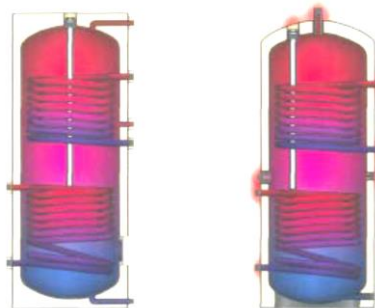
acumulador con las conexiones de entrada y salida convenientemente aisladas con otro de aislamiento deficiente. Fuente: RITE
